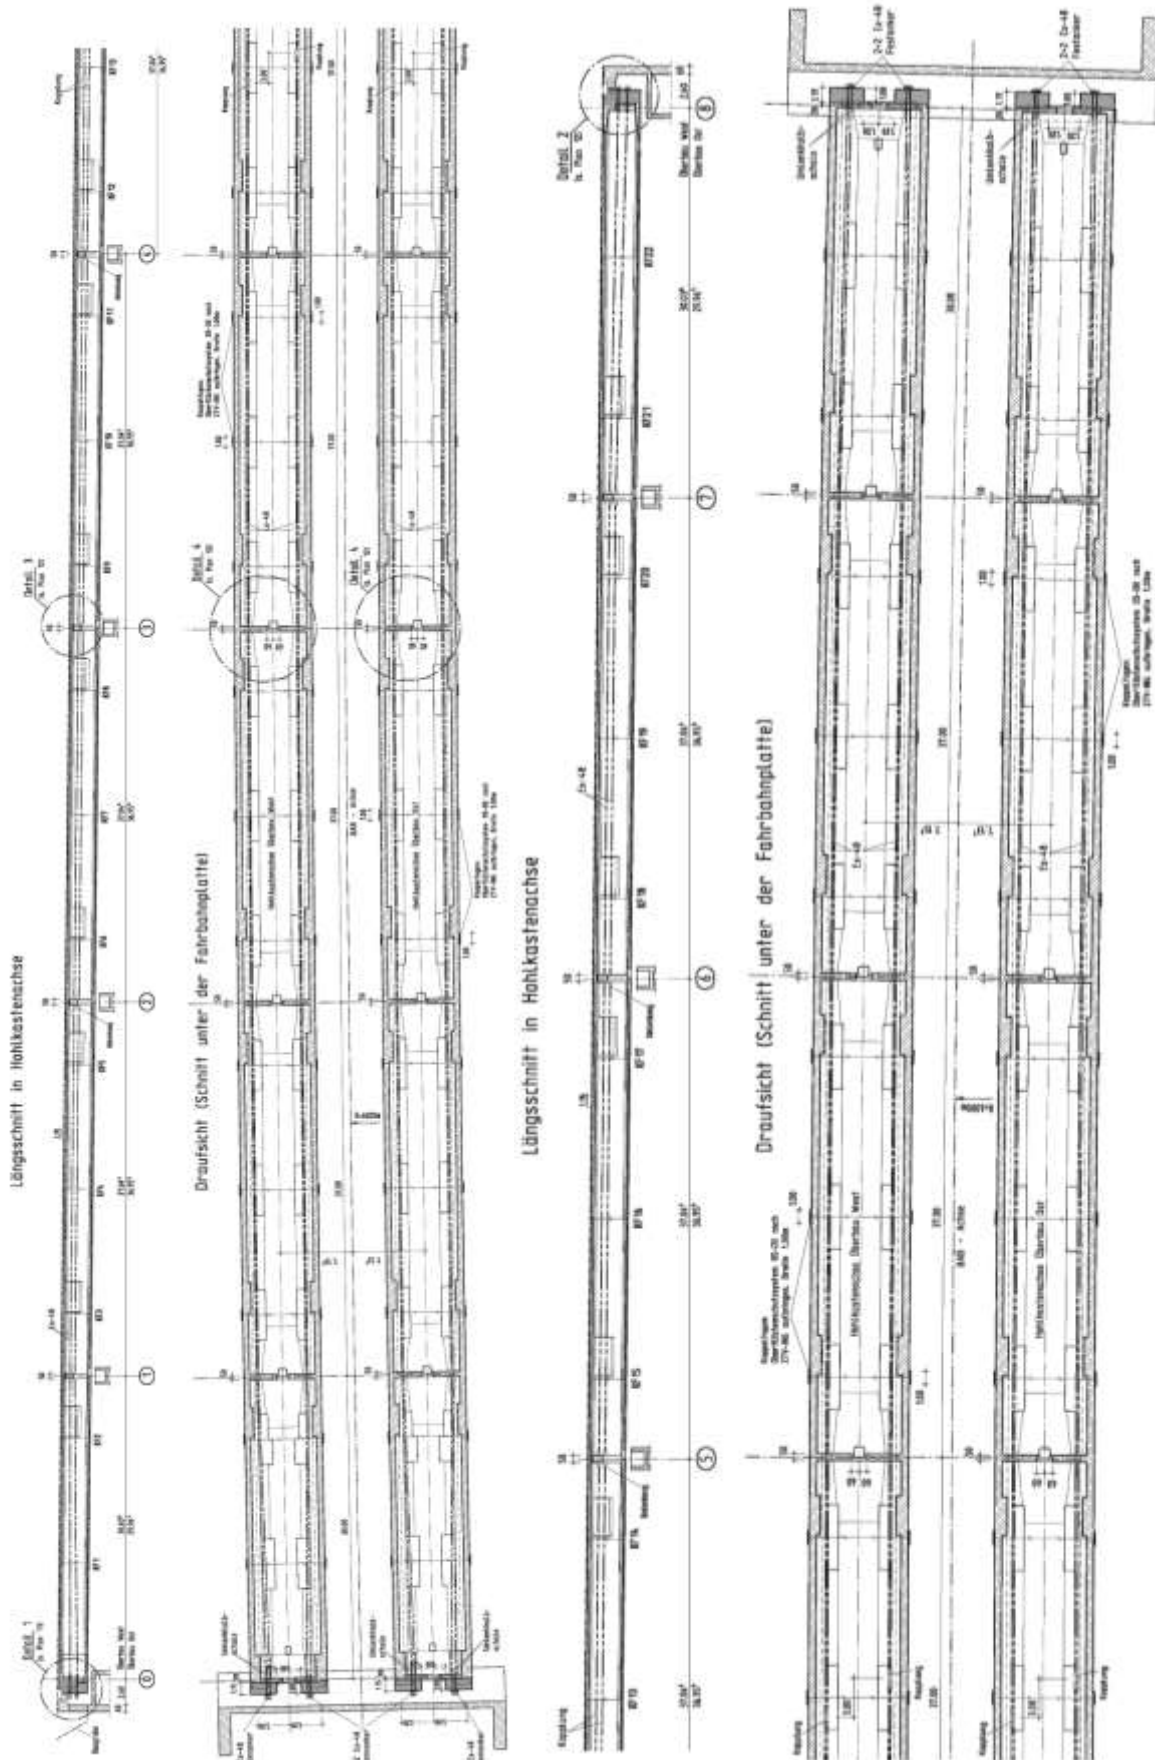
Längsschnitt und Draufsicht von beiden TBW (Entwurfsplanung)
